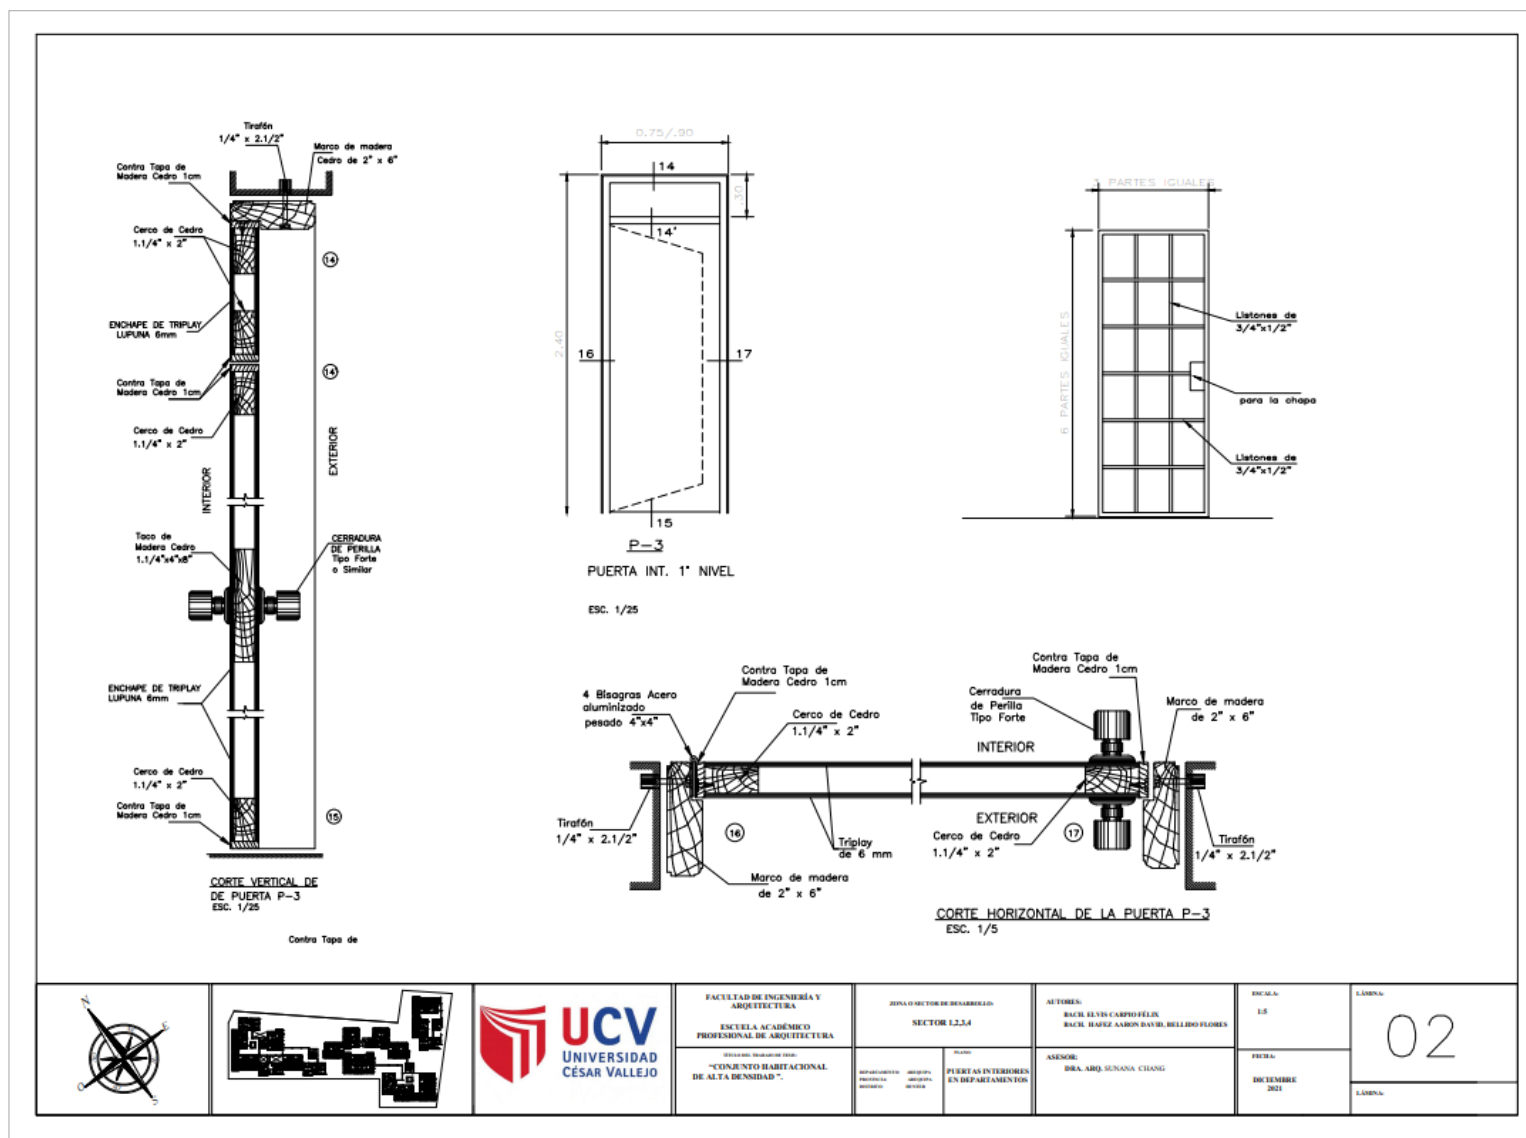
Plano de Detalle Arquitectónico – Puertas - 02
